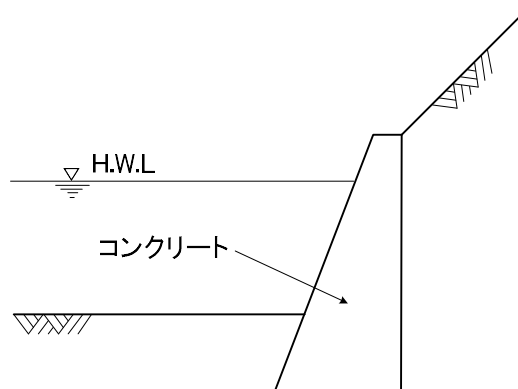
自立式護岸の例(コンクリート擁壁工)
